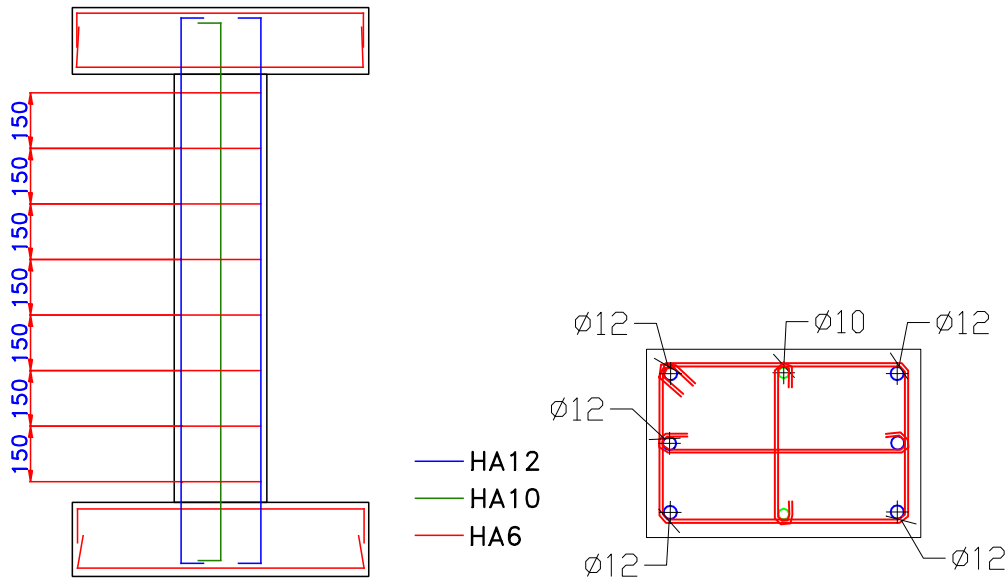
Poteau SIBA 150-0 - Plan de ferrailage.
